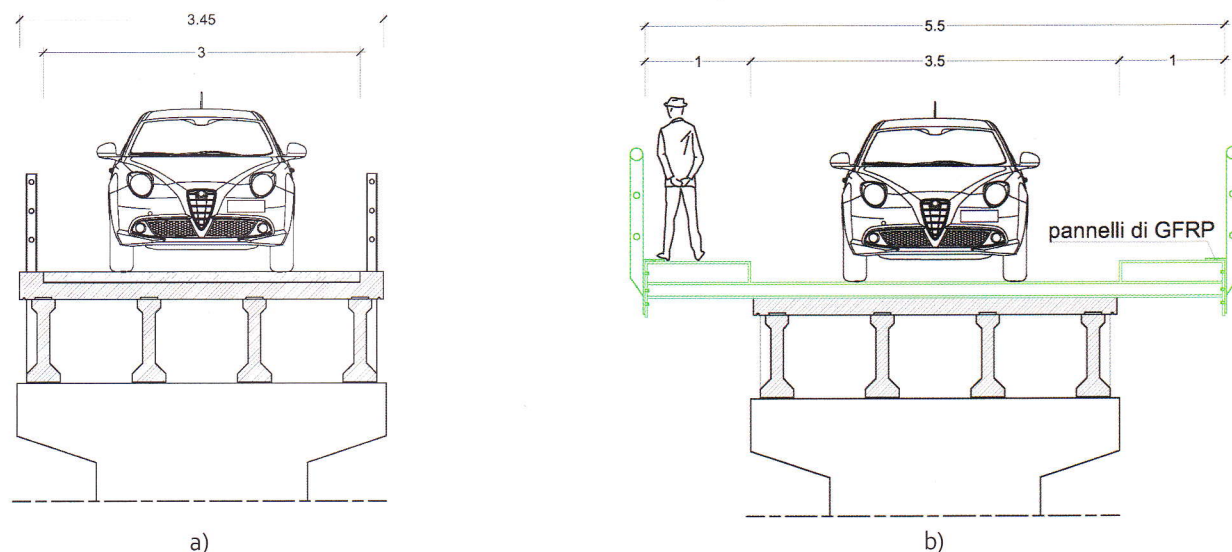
Sezione trasversale: a) stato attuale; b) ipotesi di intervento.
